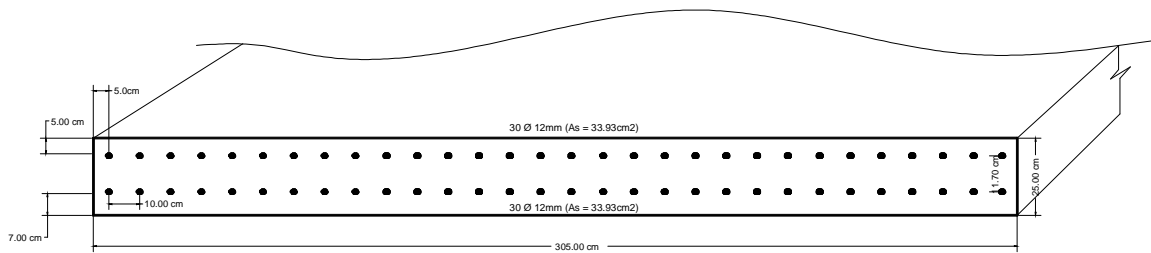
Sección Propuesta y Armado Longitudinal AUTOR Pedro Hurtado L.
